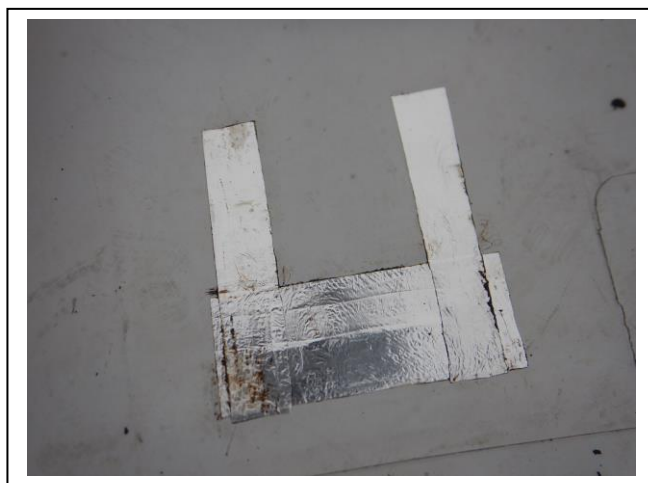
ST1 – skladba střechyFoto 083 – ST1 – skladba střechy
